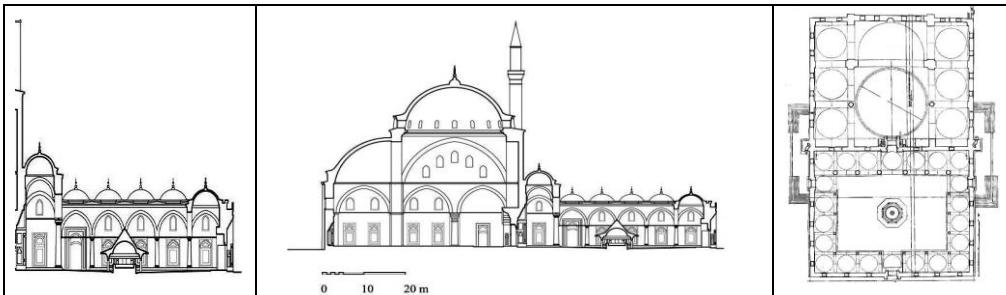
مسقط أفقى وقطع لجامع مهرماه بأدرنة قابي في إسطنبول يوضح السقيفه المزدوجة
